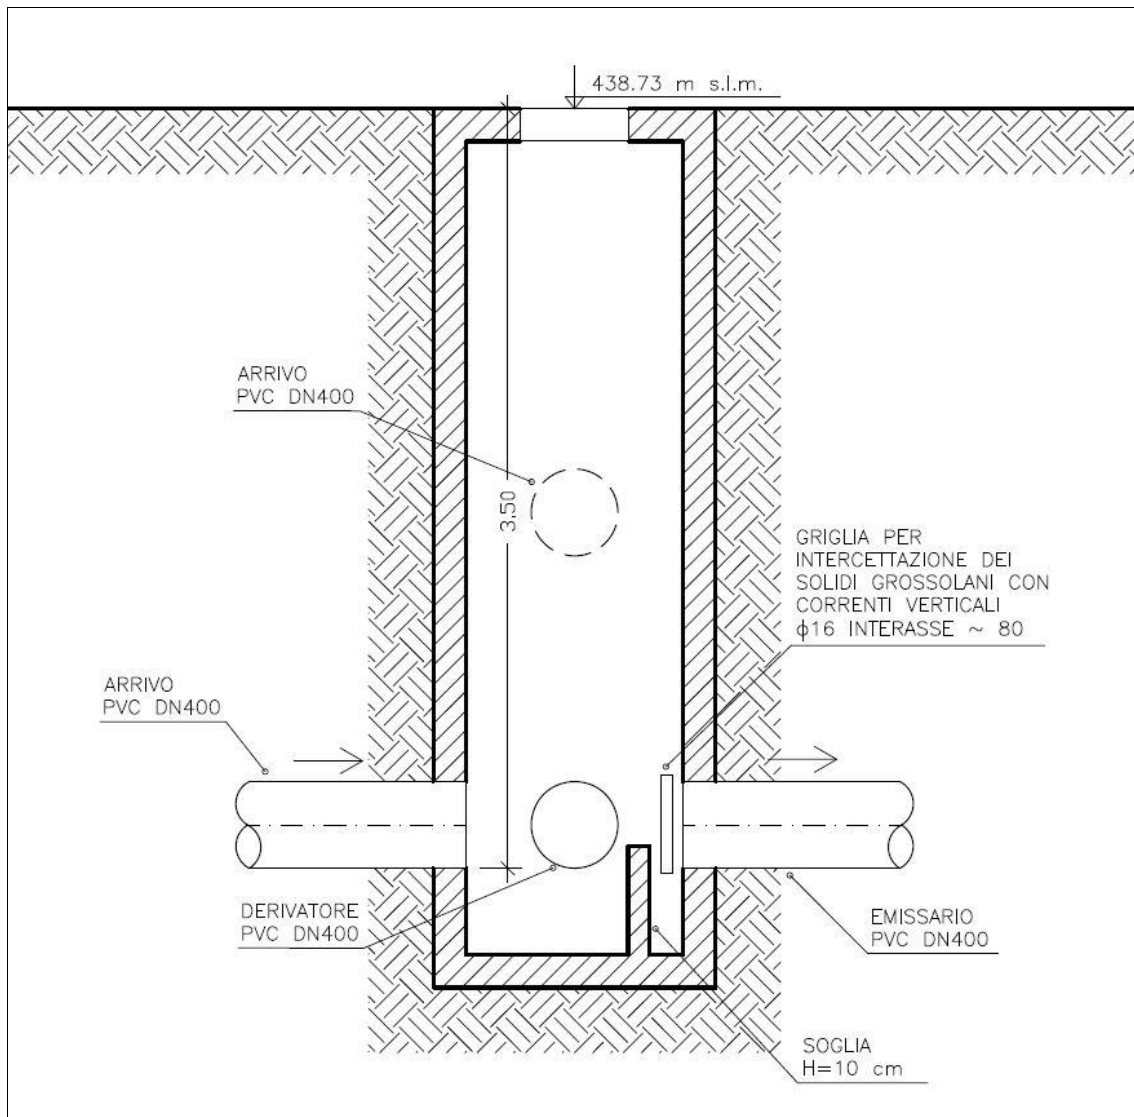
Sezione scolmatore di progetto – Pozzetto E
